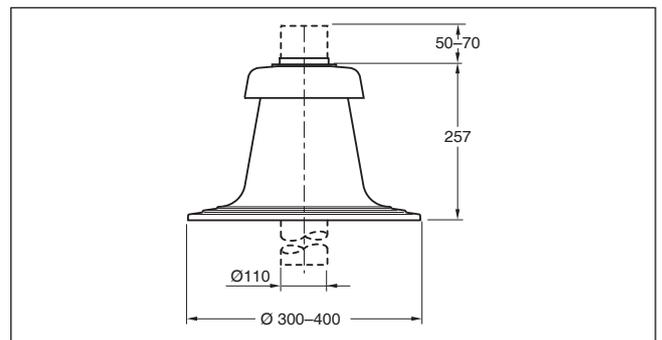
Schachtabdeckung für 110 mm (Maße in mm)
